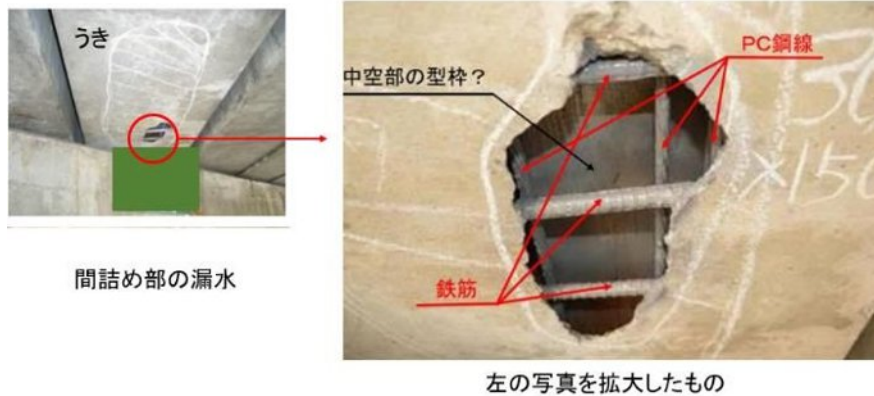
桁製作時にコンクリートの充填不良が生じた桁の例
